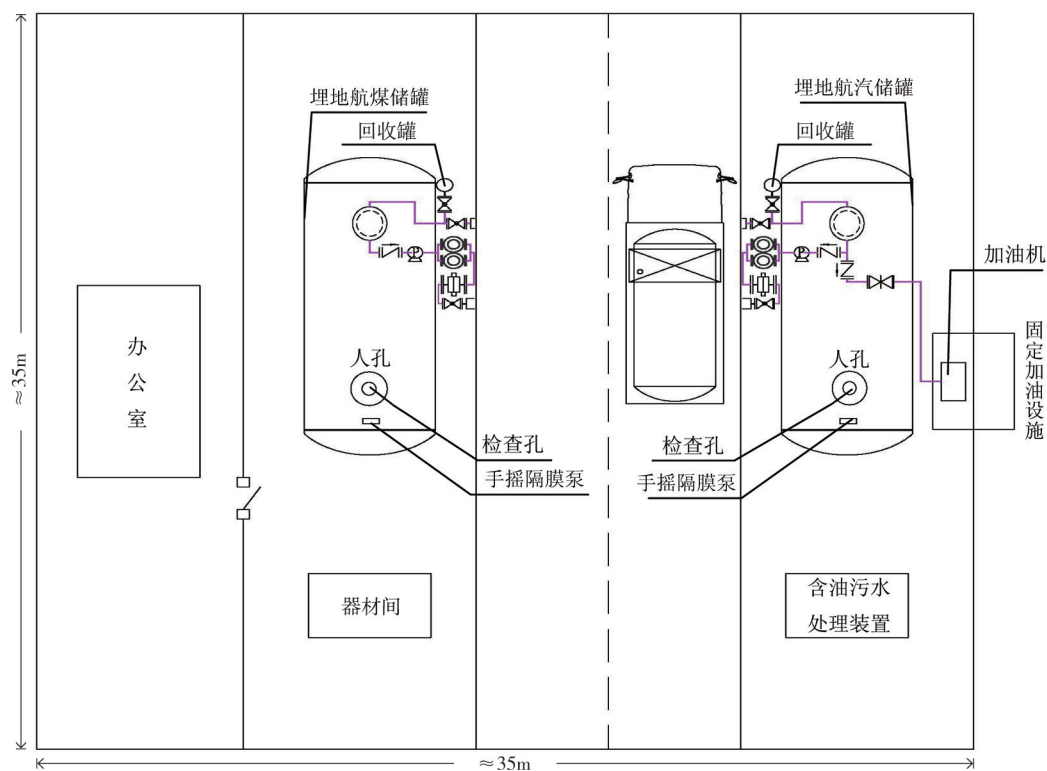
某通用机场加油站设施设备平面图 1
